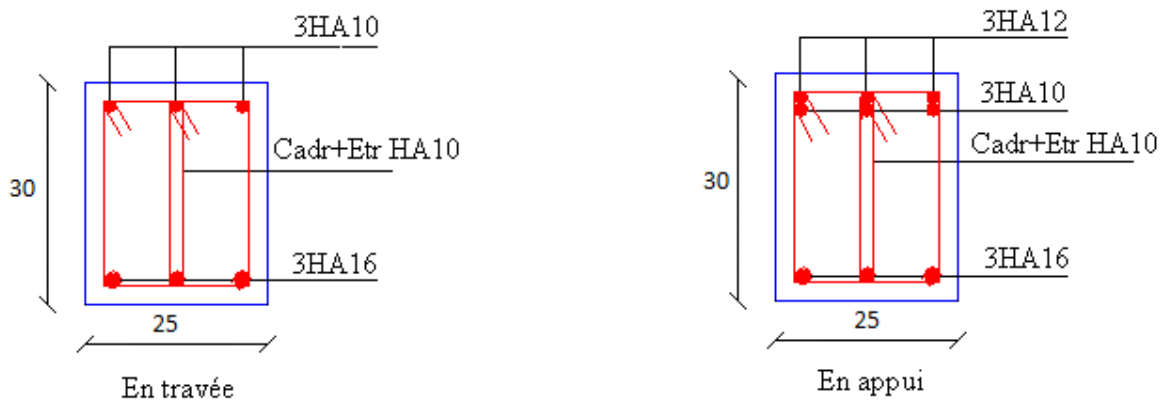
Schéma du ferrailage des poutres secondaire d'étage courant
